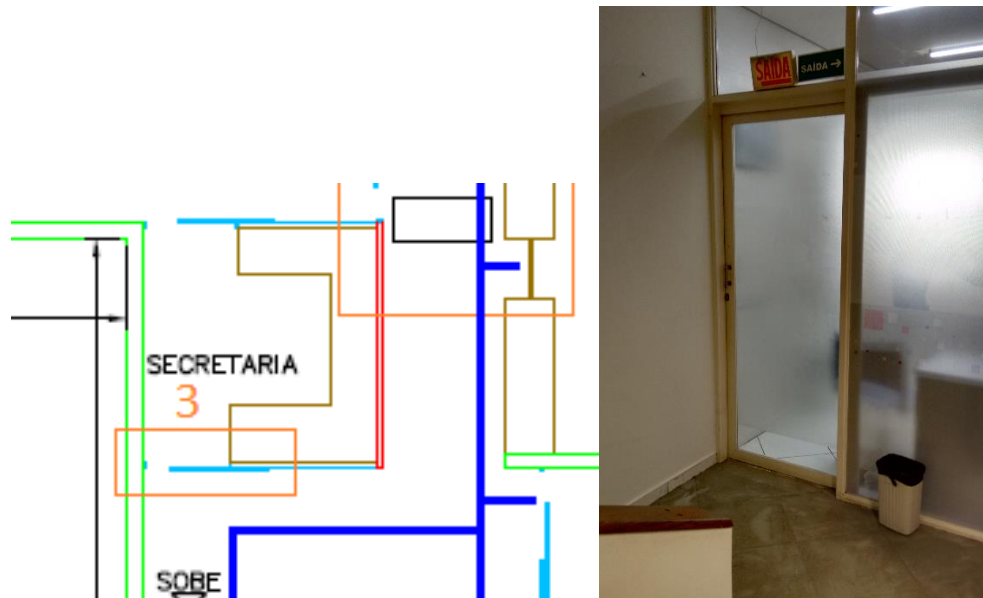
Destaque da Planta e foto da porta de acesso para secretaria
